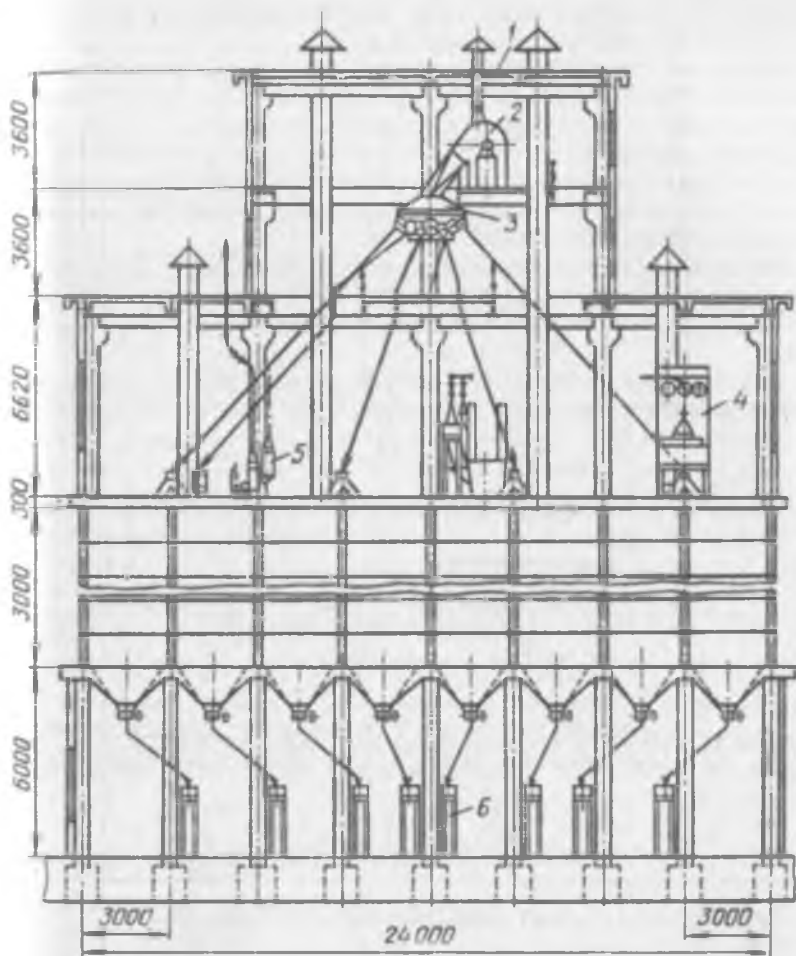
Разрез силосного корпуса с загрузкой силосов зерном через поворотные трубы:
